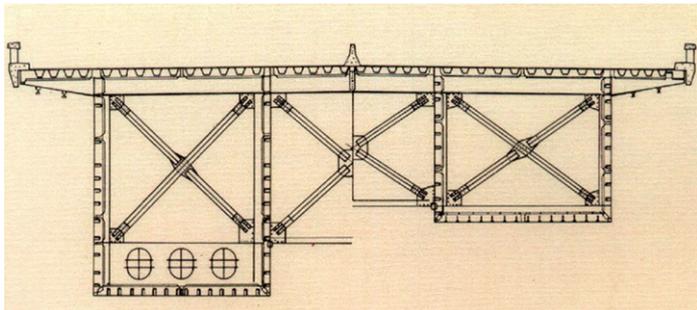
SEÇÃO TRANSVERSAL DA PONTE DE AÇO COM A LAJE ORTOTRÓPICA
